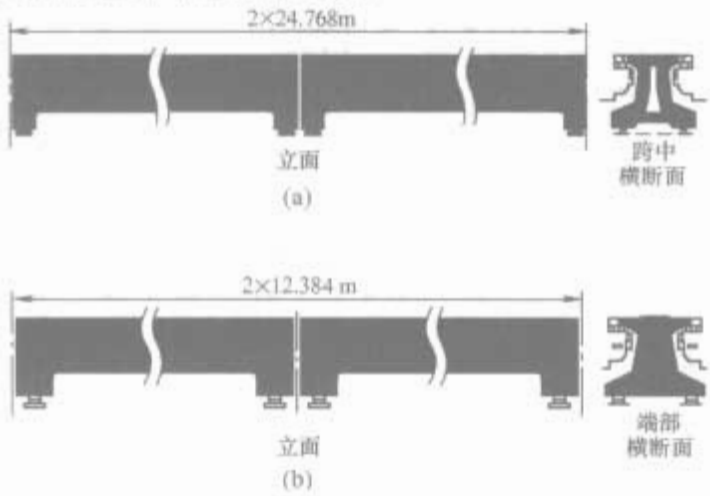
两种标准跨径预应力钢筋混凝土复合梁
